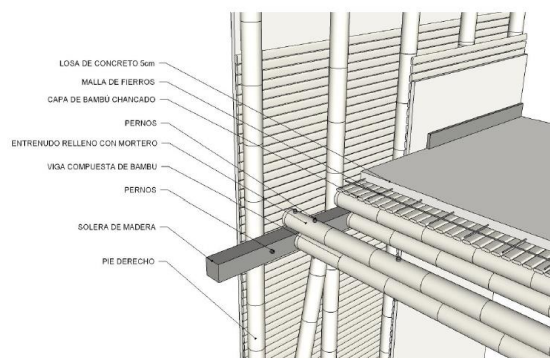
Laje 1 - (Ministerio de Vivienda, C.y.S.d.P., 2012)
